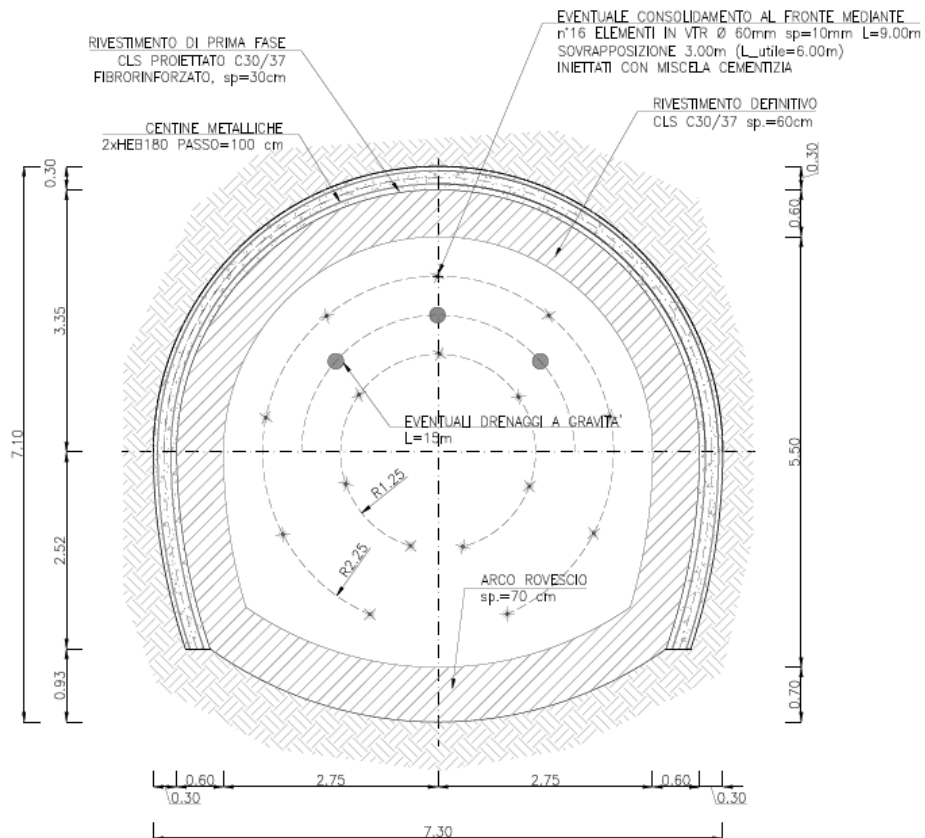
Sezione tipo GI-4: geometria del cavo e interventi di sostegno
